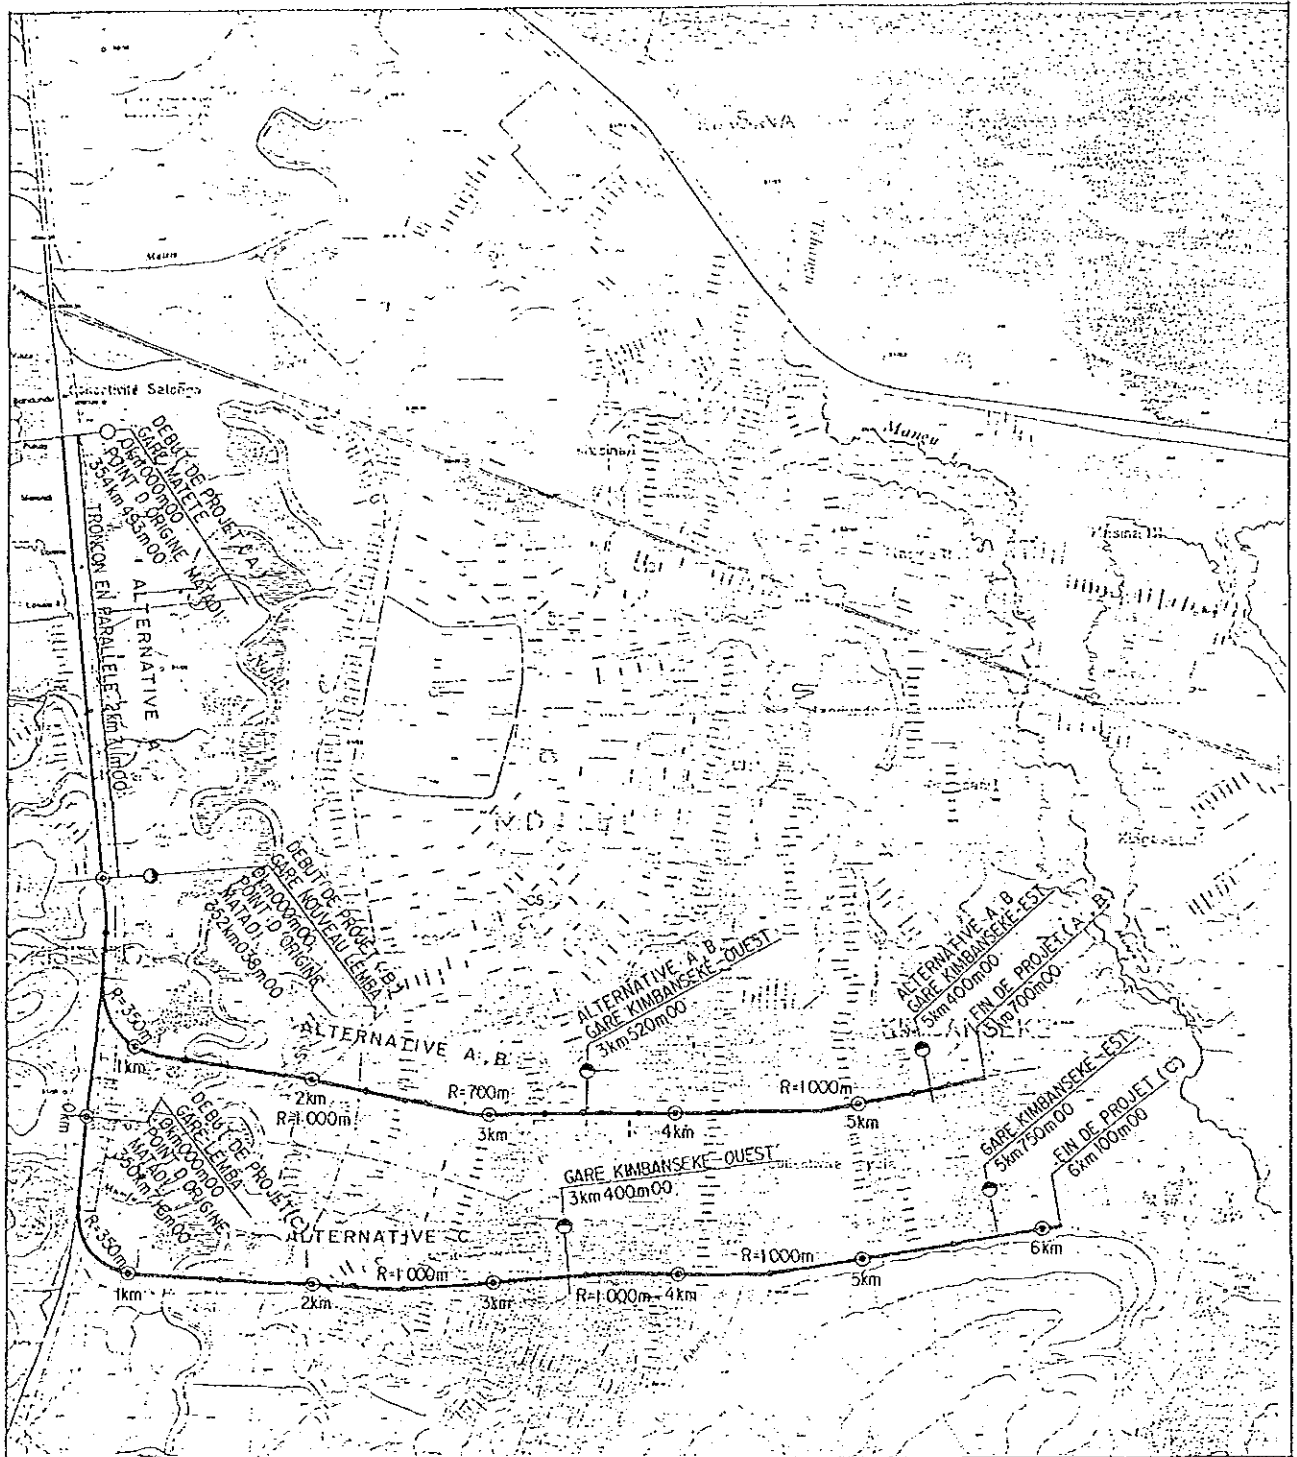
PLAN DES ALTERNATIVES DU TRACE
